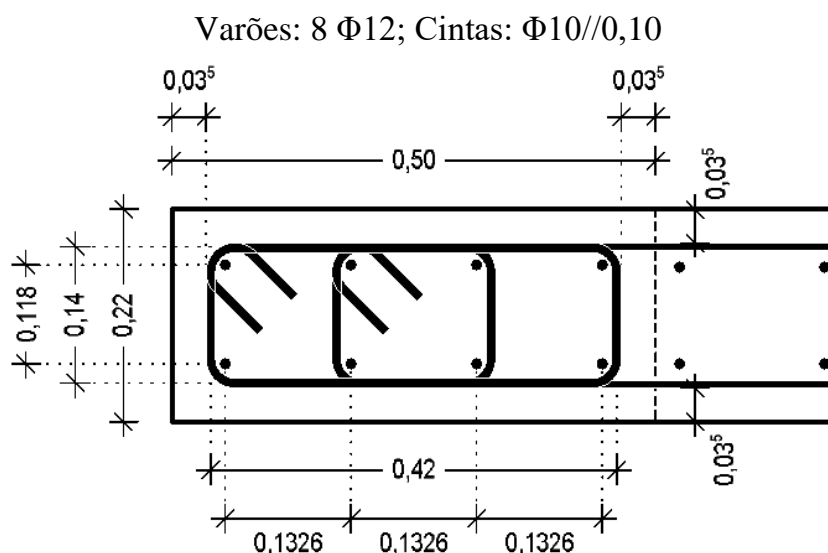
Dimensões do pilar fictício da parede exemplo para a verificação da ductilidade local.
